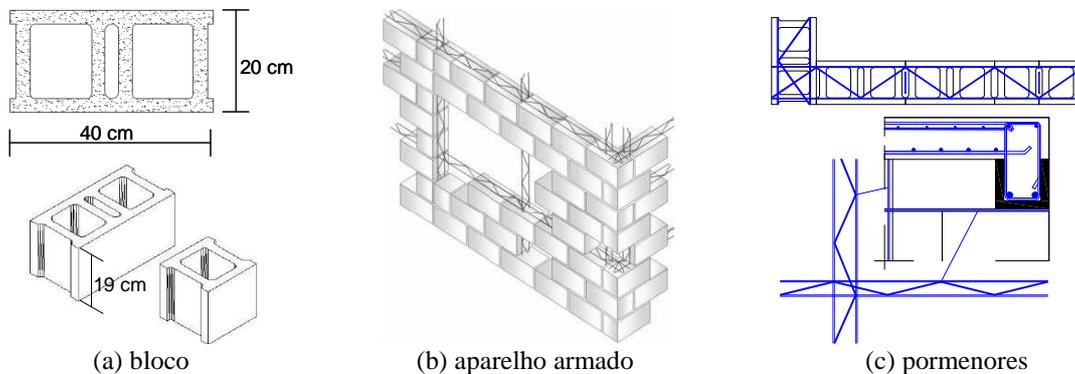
Sistema de alvenaria integrado com blocos de betão e armadura treliçada
